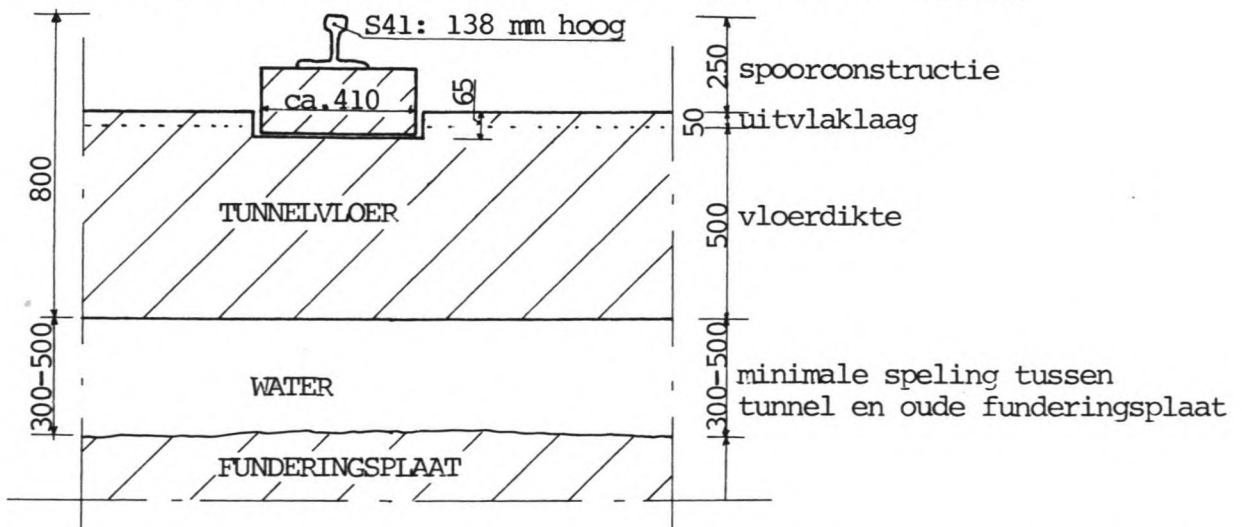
Doorsnede over rail, tunnelvloer en bovenzijde van oude funderingsplaat bij de zuidelijke tunneloprit. Maten in mm .
